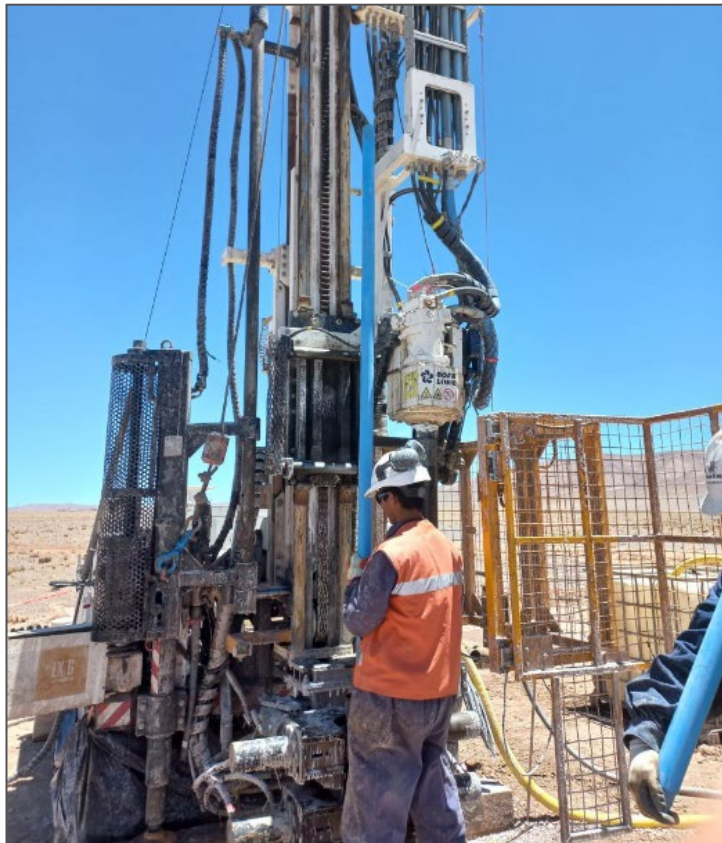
Construcción de piezómetro – instalación de tubo de PVC
